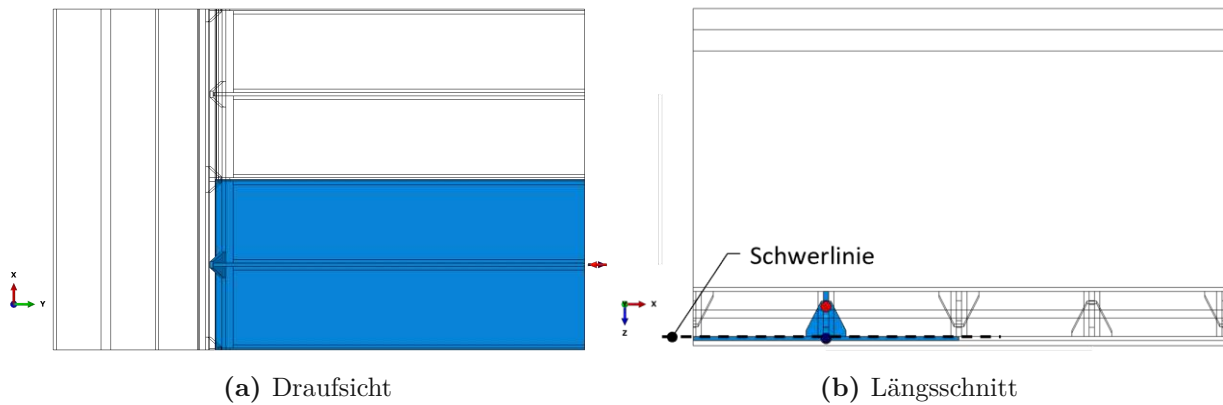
Tragwirkung T-Querschnitt unten: (a) Draufsicht (b) Längsschnitt
